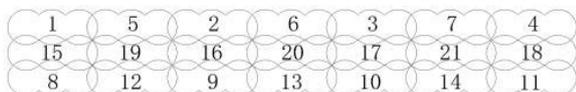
是三轴搅拌桩施工方法的加固层施工顺序示意图；
